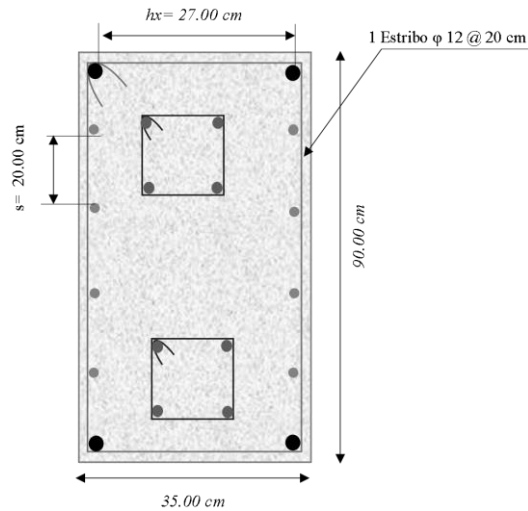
Armado de las vigas de acople de la geometría 1 en base al DDBD
